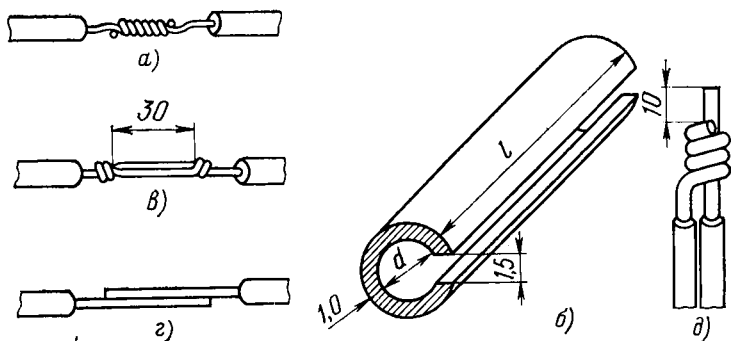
Подготовка к соединению жил проводов и кабелей.
